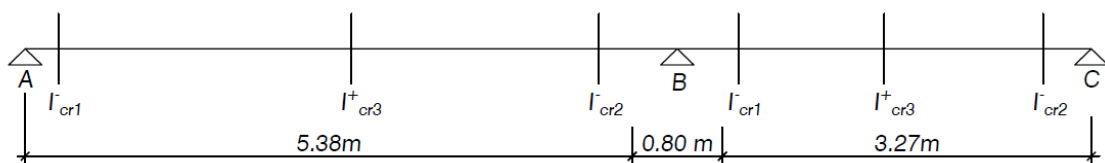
Secciones de cálculo de inercias agrietadas en la viga
